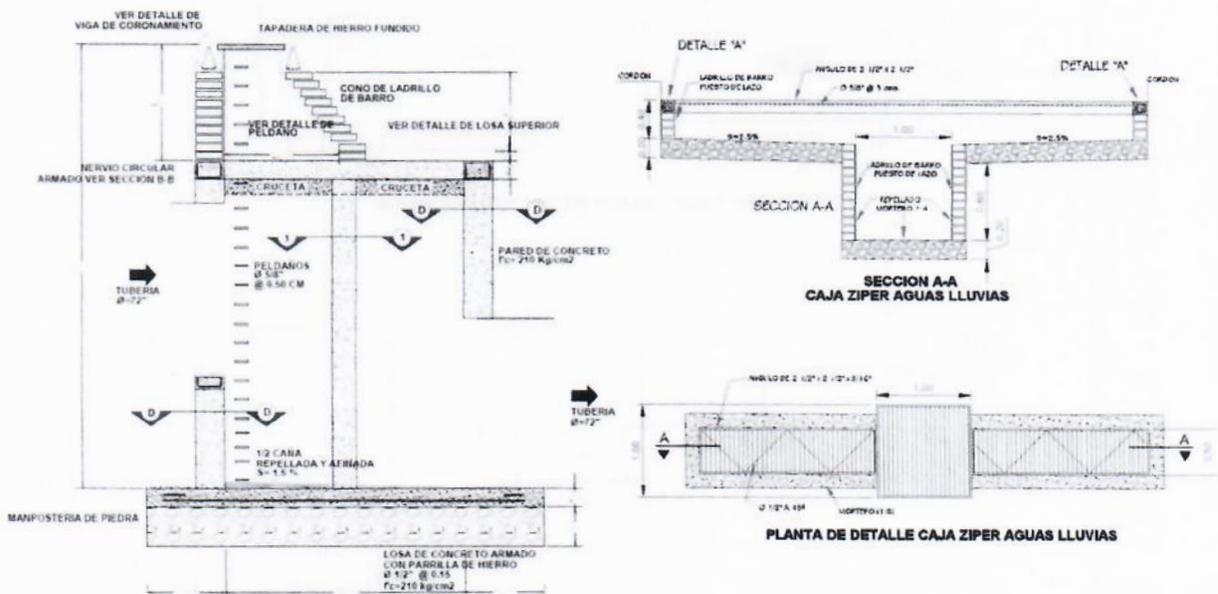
, Detalle típico de caja Ziper y posos de concreto reforzado.
